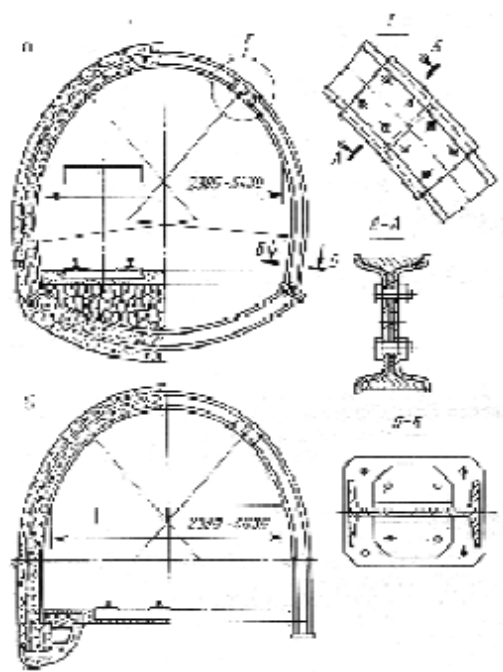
Металобетонне кріплення з жорсткими рамами із двотавру:
